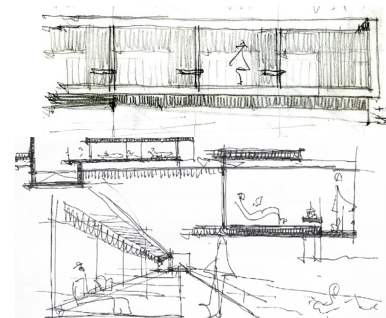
Croquis galería de acceso a las viviendas para mayores en San Vicente del Raspeig. (2002-2008). Javier García-Solera. Del arquitecto
